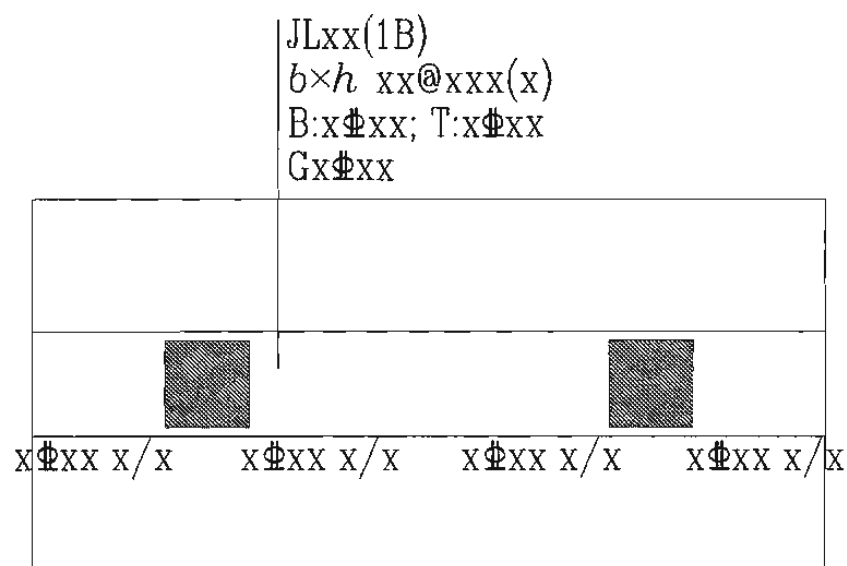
双柱独立基础的基础梁配筋注写示意
